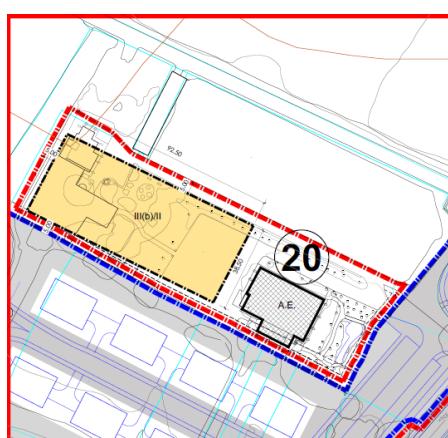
Plano modificado del área 20 Villa Lucía en Laguardia
